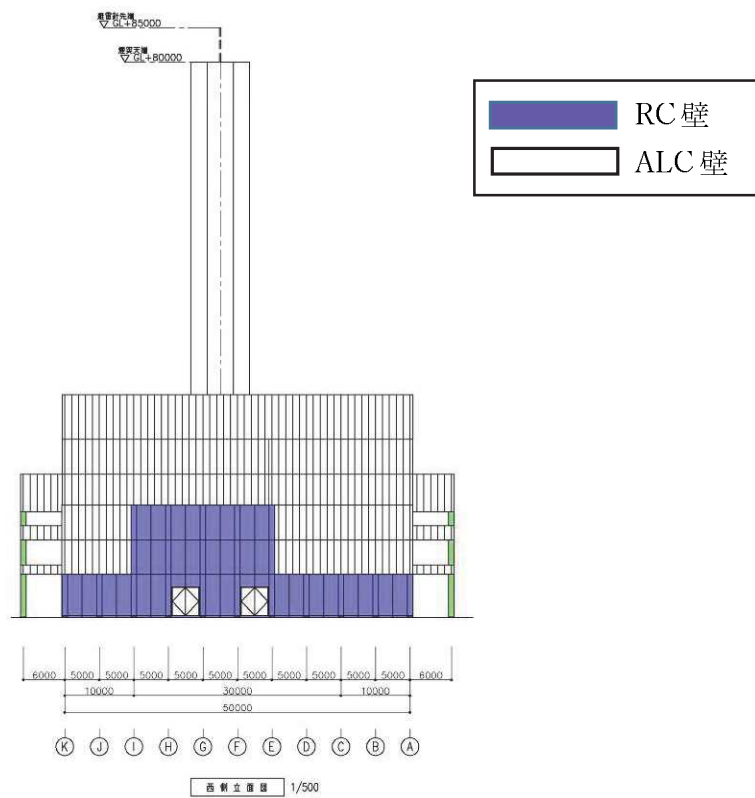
(3) 外壁の配置 (西側立面図)
